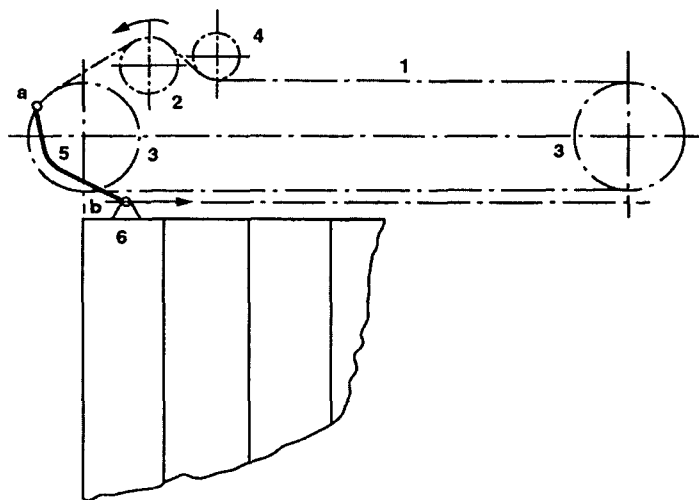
Схема приводного механизма многостворчатой раздвижной двери
